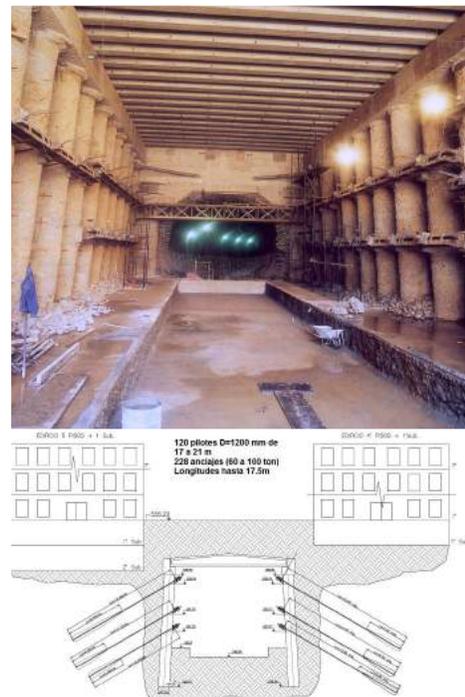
Solución mediante pilotes anclados para la construcción de la estación Bellas Artes en la extensión de la línea 5 del metro de Santiago (Foto gentileza de Pilotes Terratest Chile)
